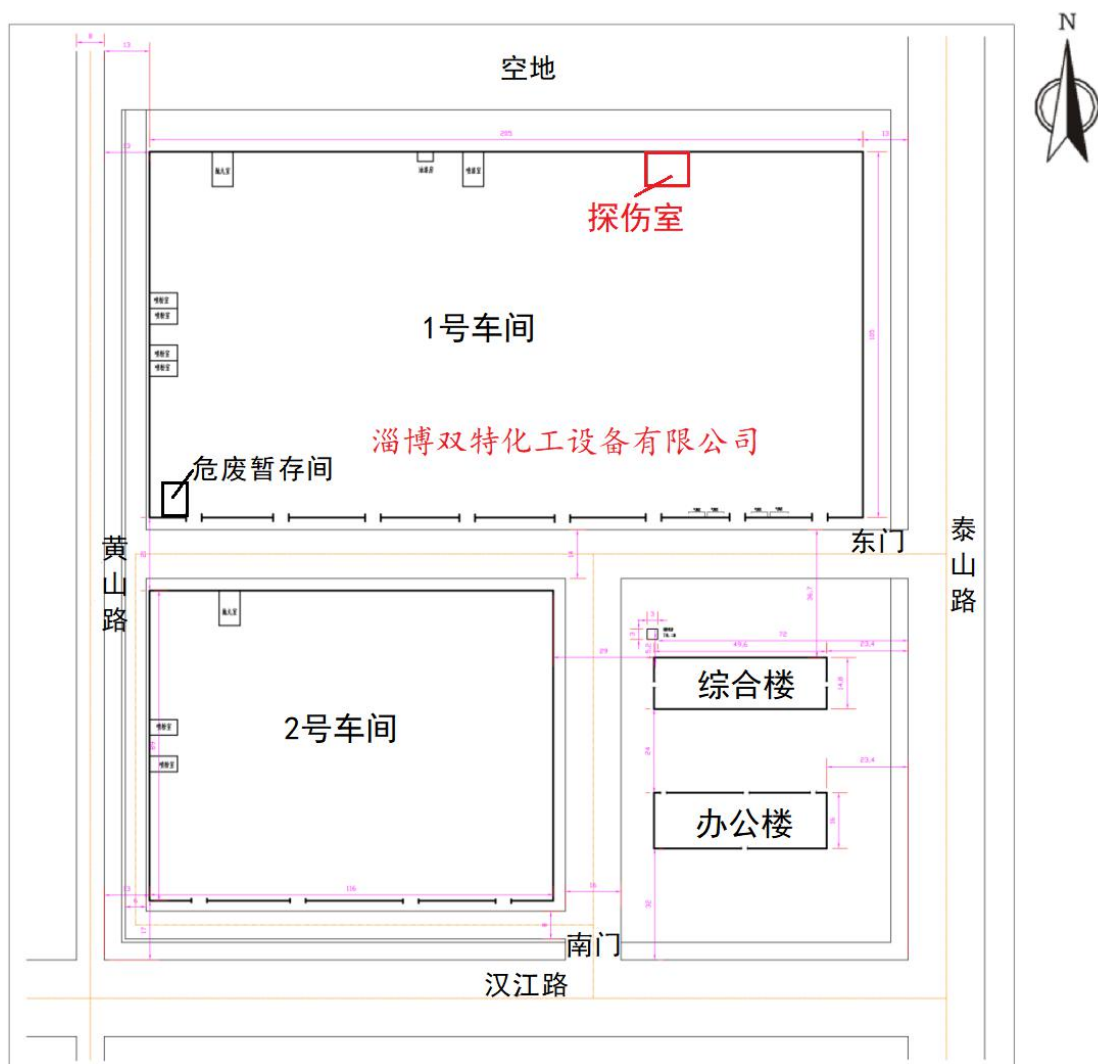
淄博双特化工设备有限公司总平面布置示意图
